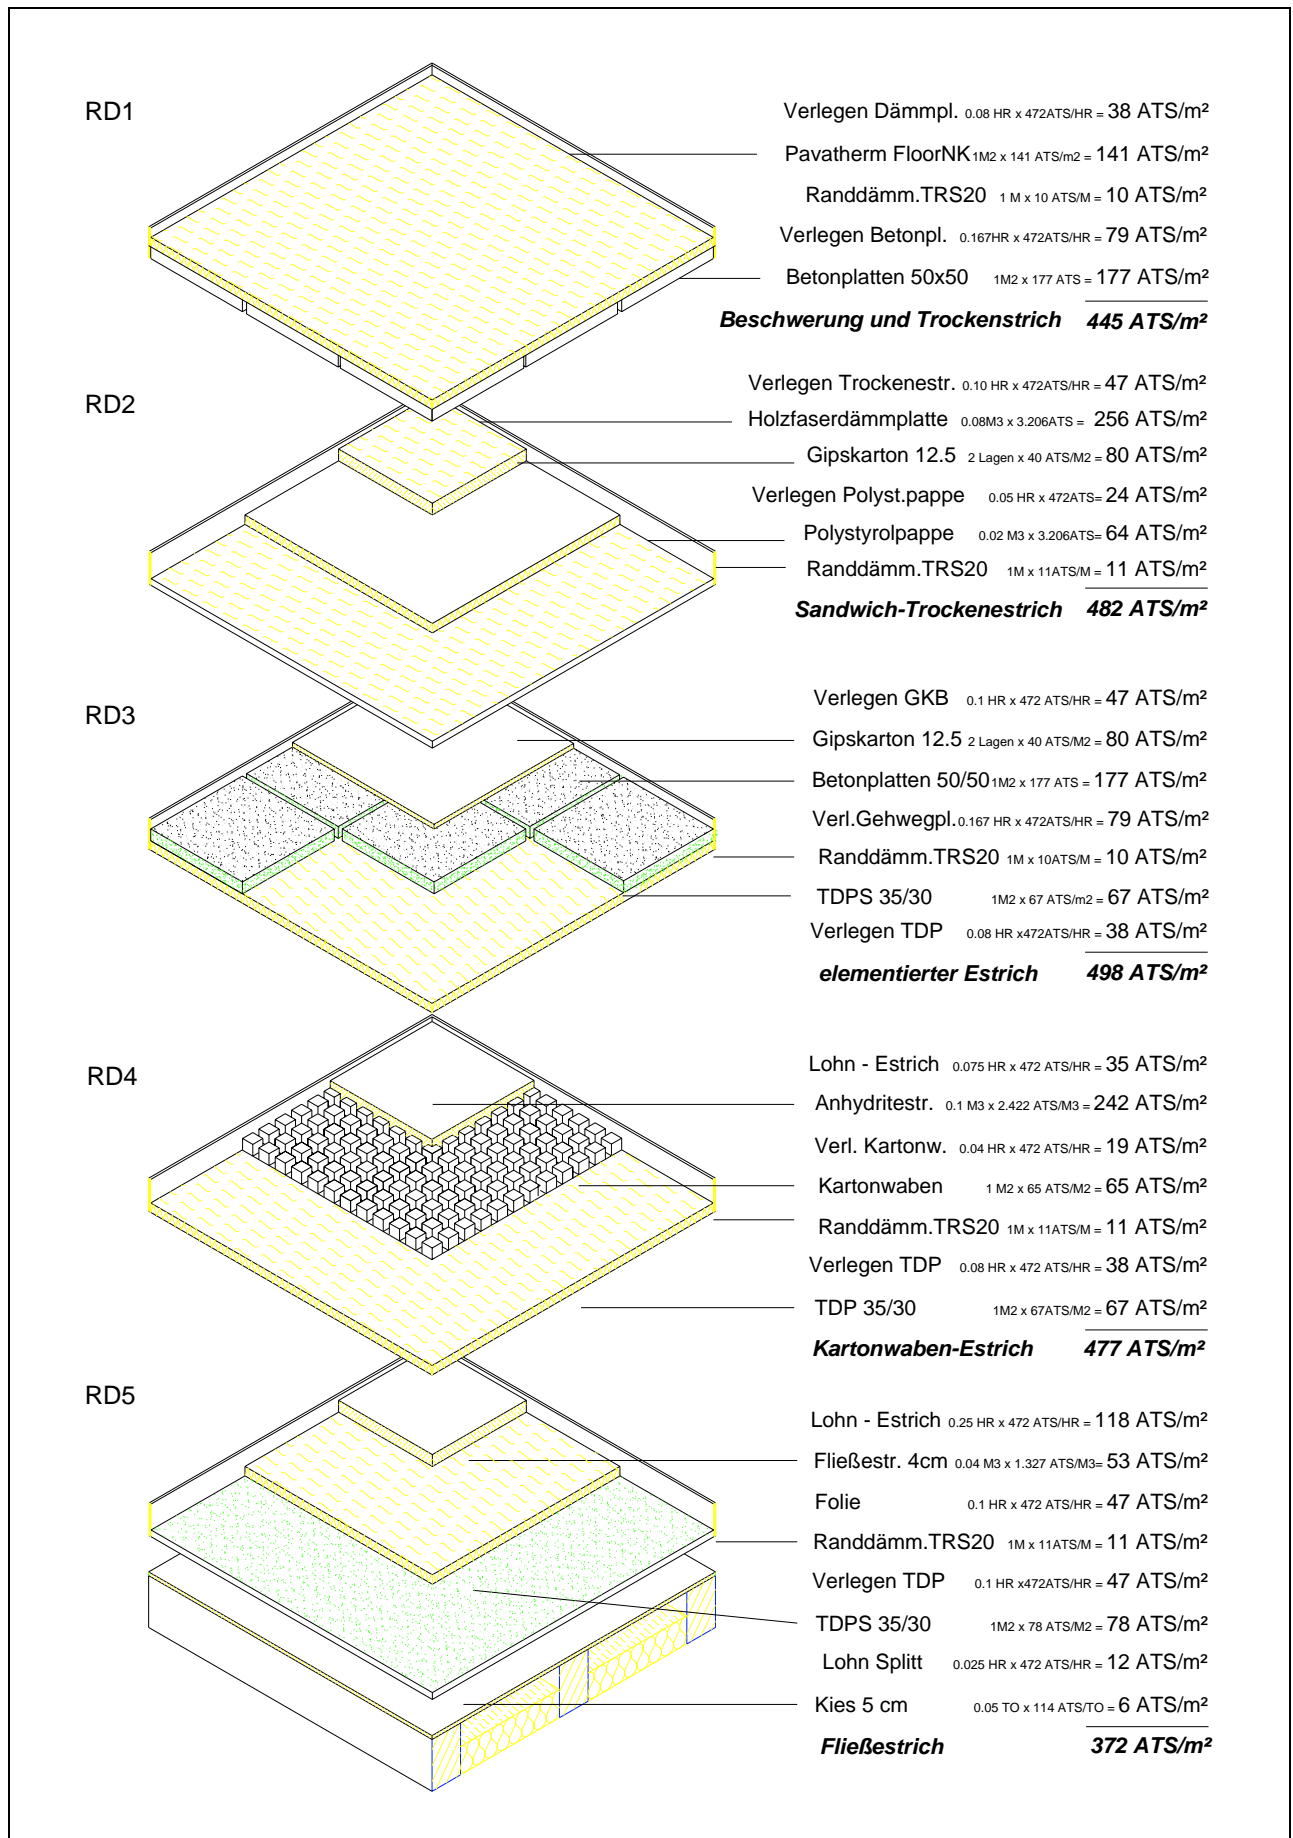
Rohdecke und Fußbodenaufbau für RD1, RD2, RD3, RD4,
